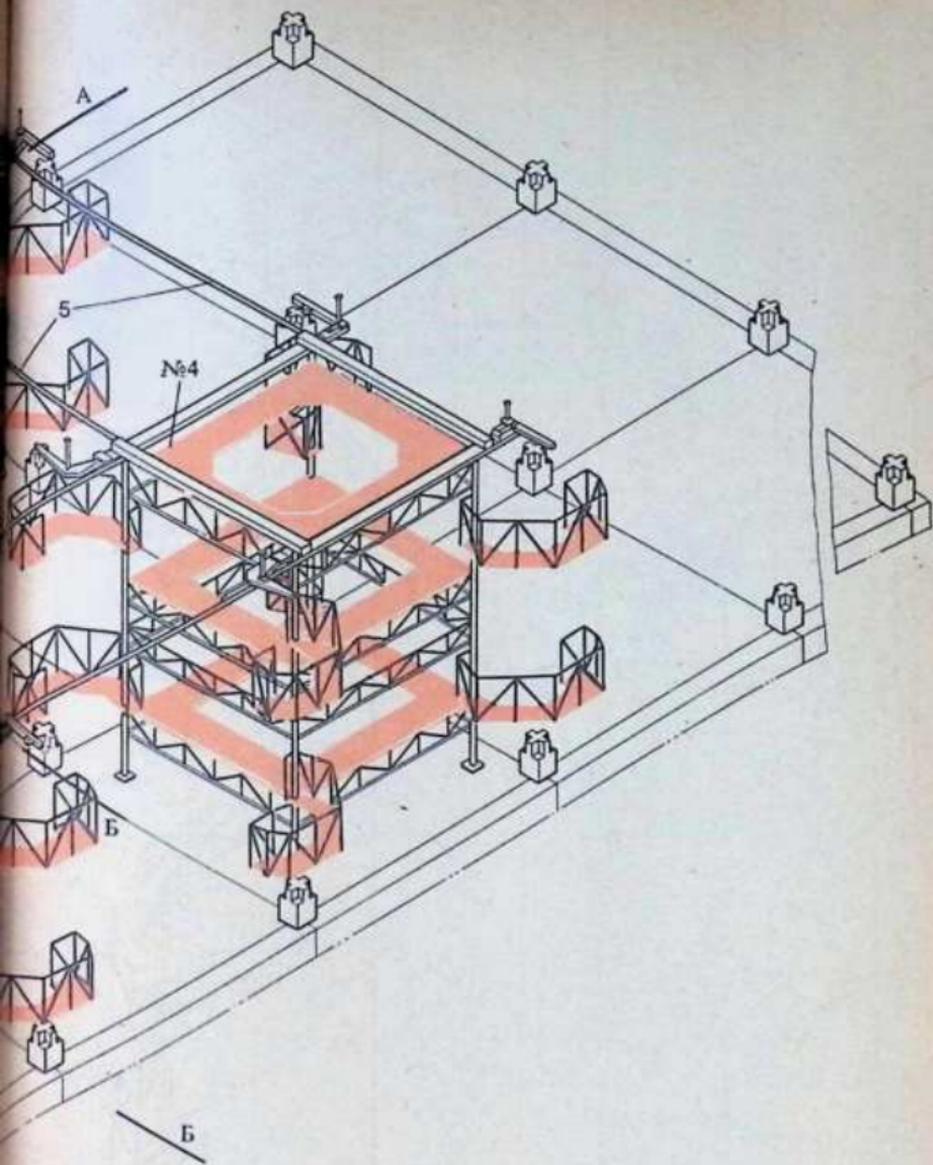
Схема расстановки комплекта рано-шарнирных индикаторов (РШИ) при монтаже каркаса здания:
